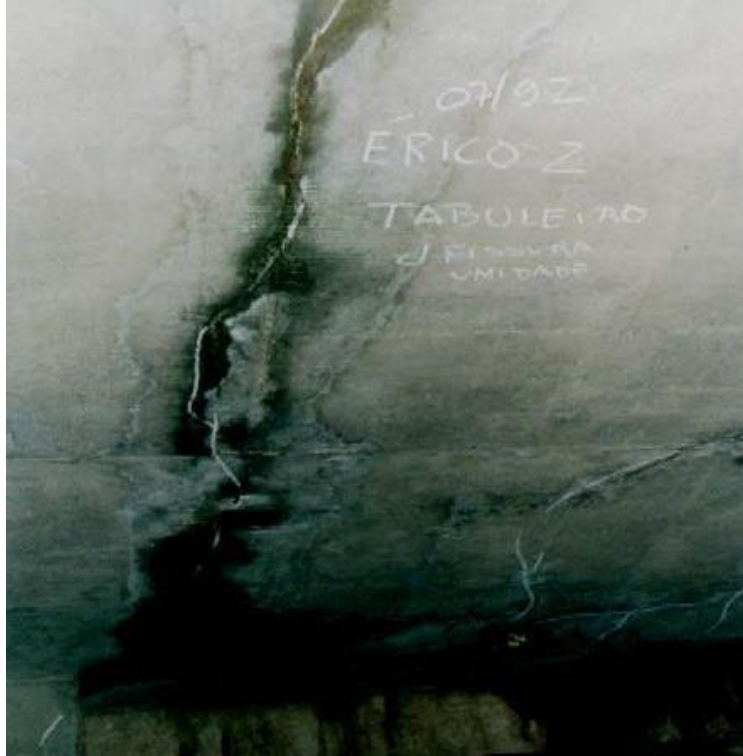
Fissuração da laje inferior da Ponte Érico Veríssimo [47].
